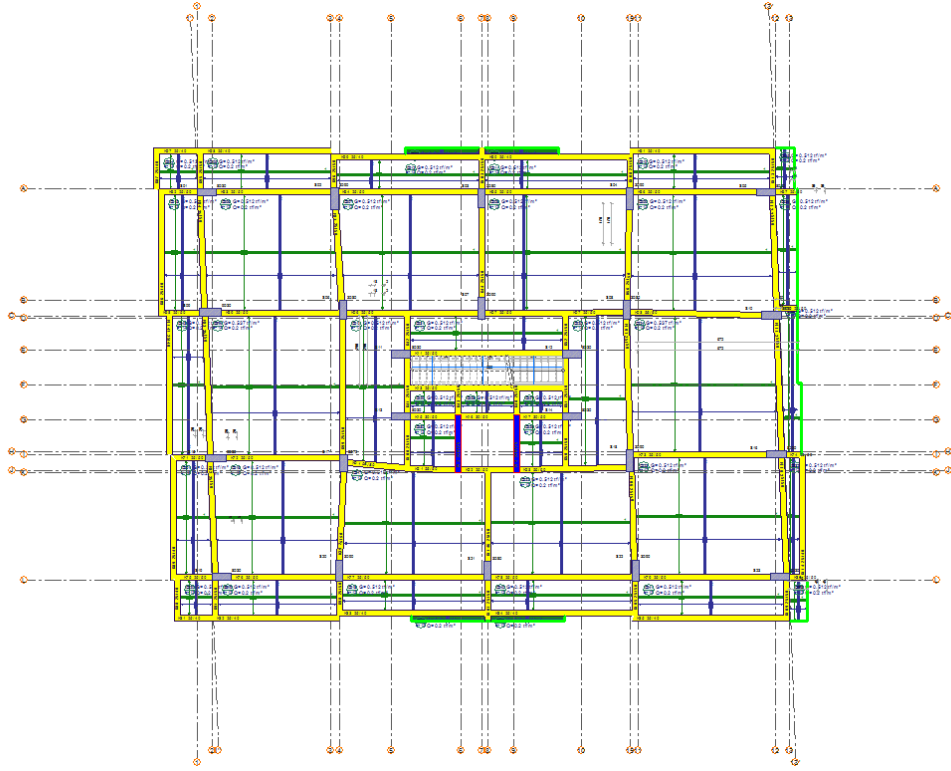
Bina kodu F için plak döşemeli haline ait kalıp planı
